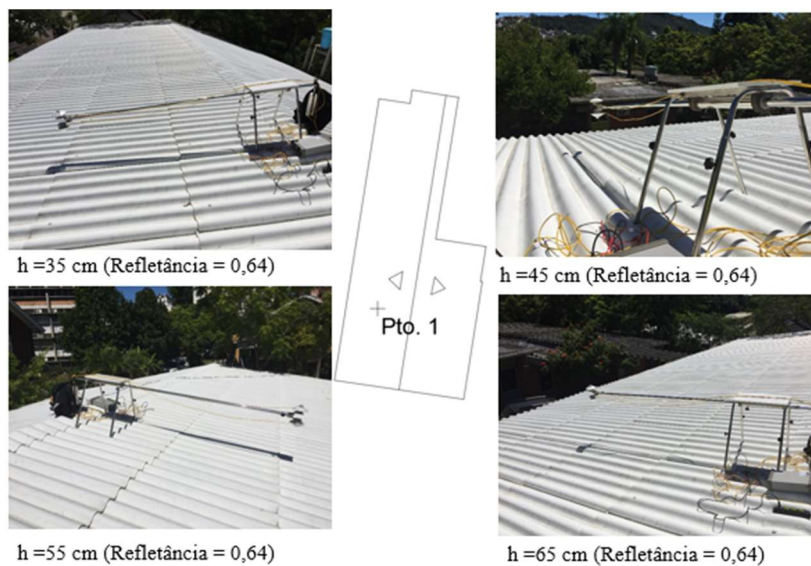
Fotos com a alturas testadas e a planta de cobertura do local da medição.
